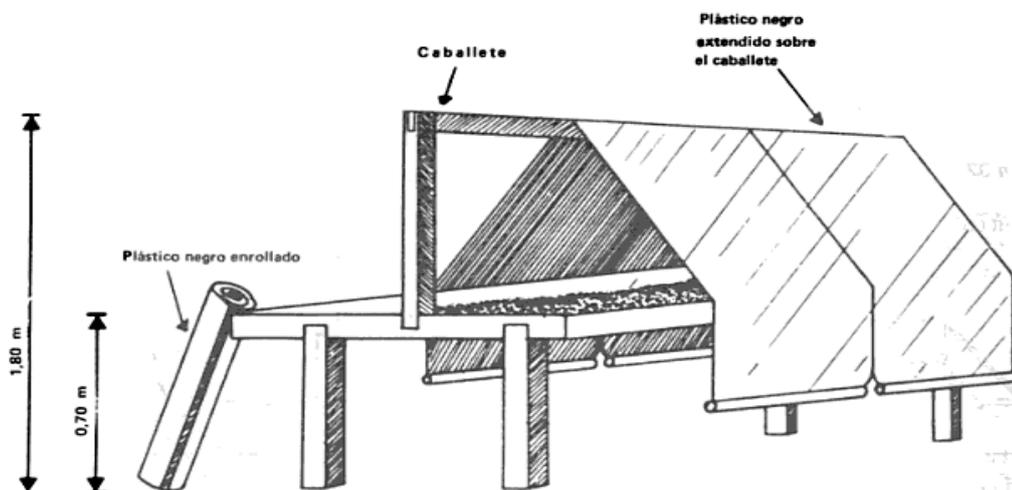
Tendal económico construido a base de madera, provisto de cubierta plástica fácilmente enrollable.
